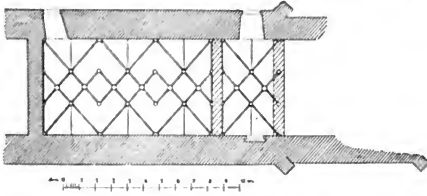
Bechin. Grundriss der gewesenen Schlosskirche.
